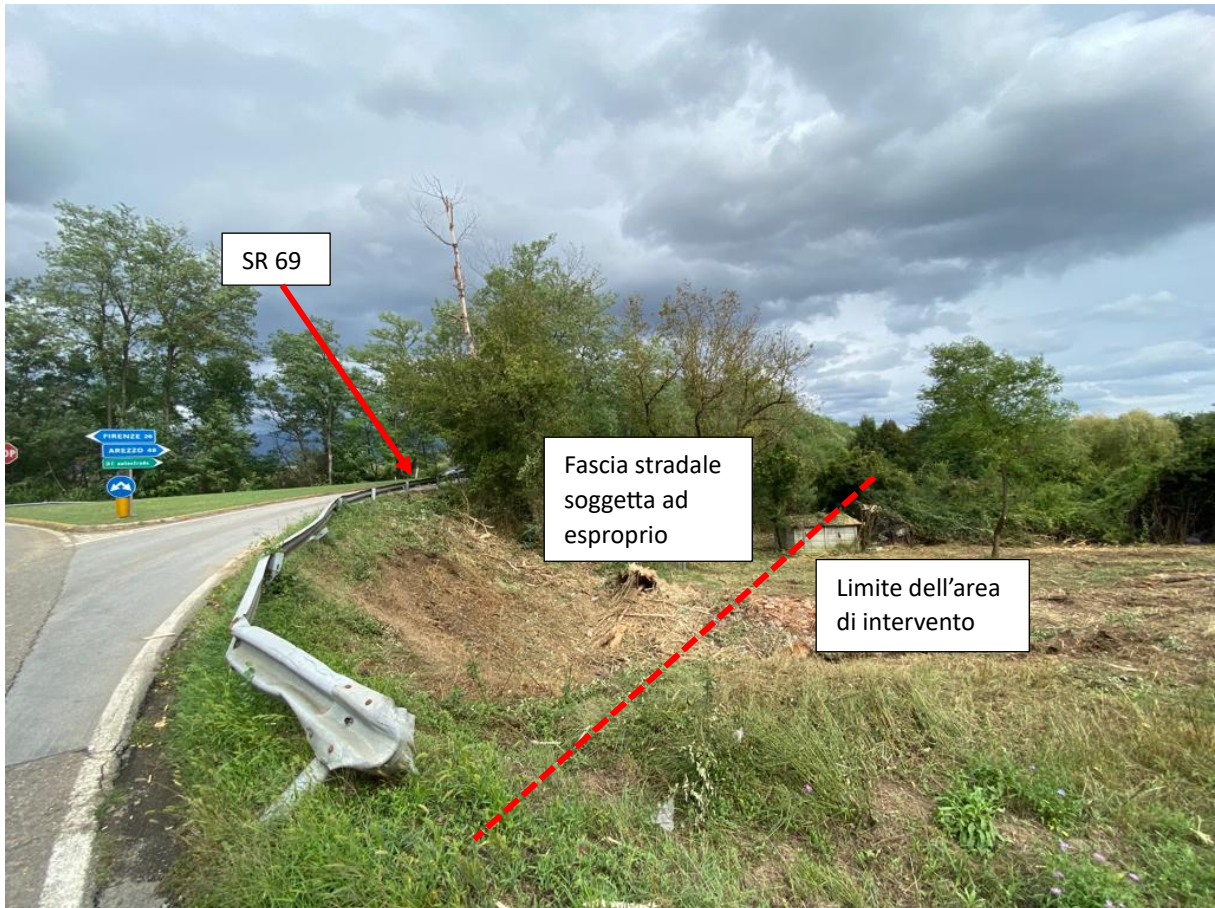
Vista dell'area dall'incrocio con la S.R. n. 69
